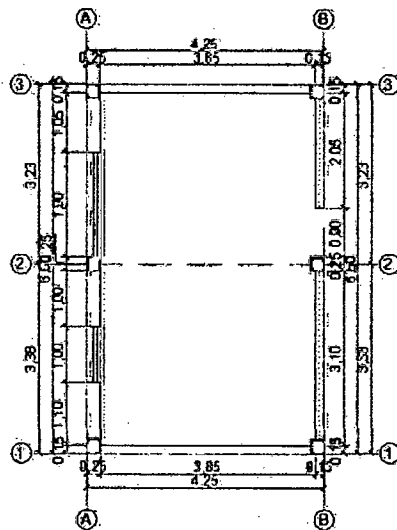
Plano de arquitectura de la planta típica de la Vivienda TV7.
